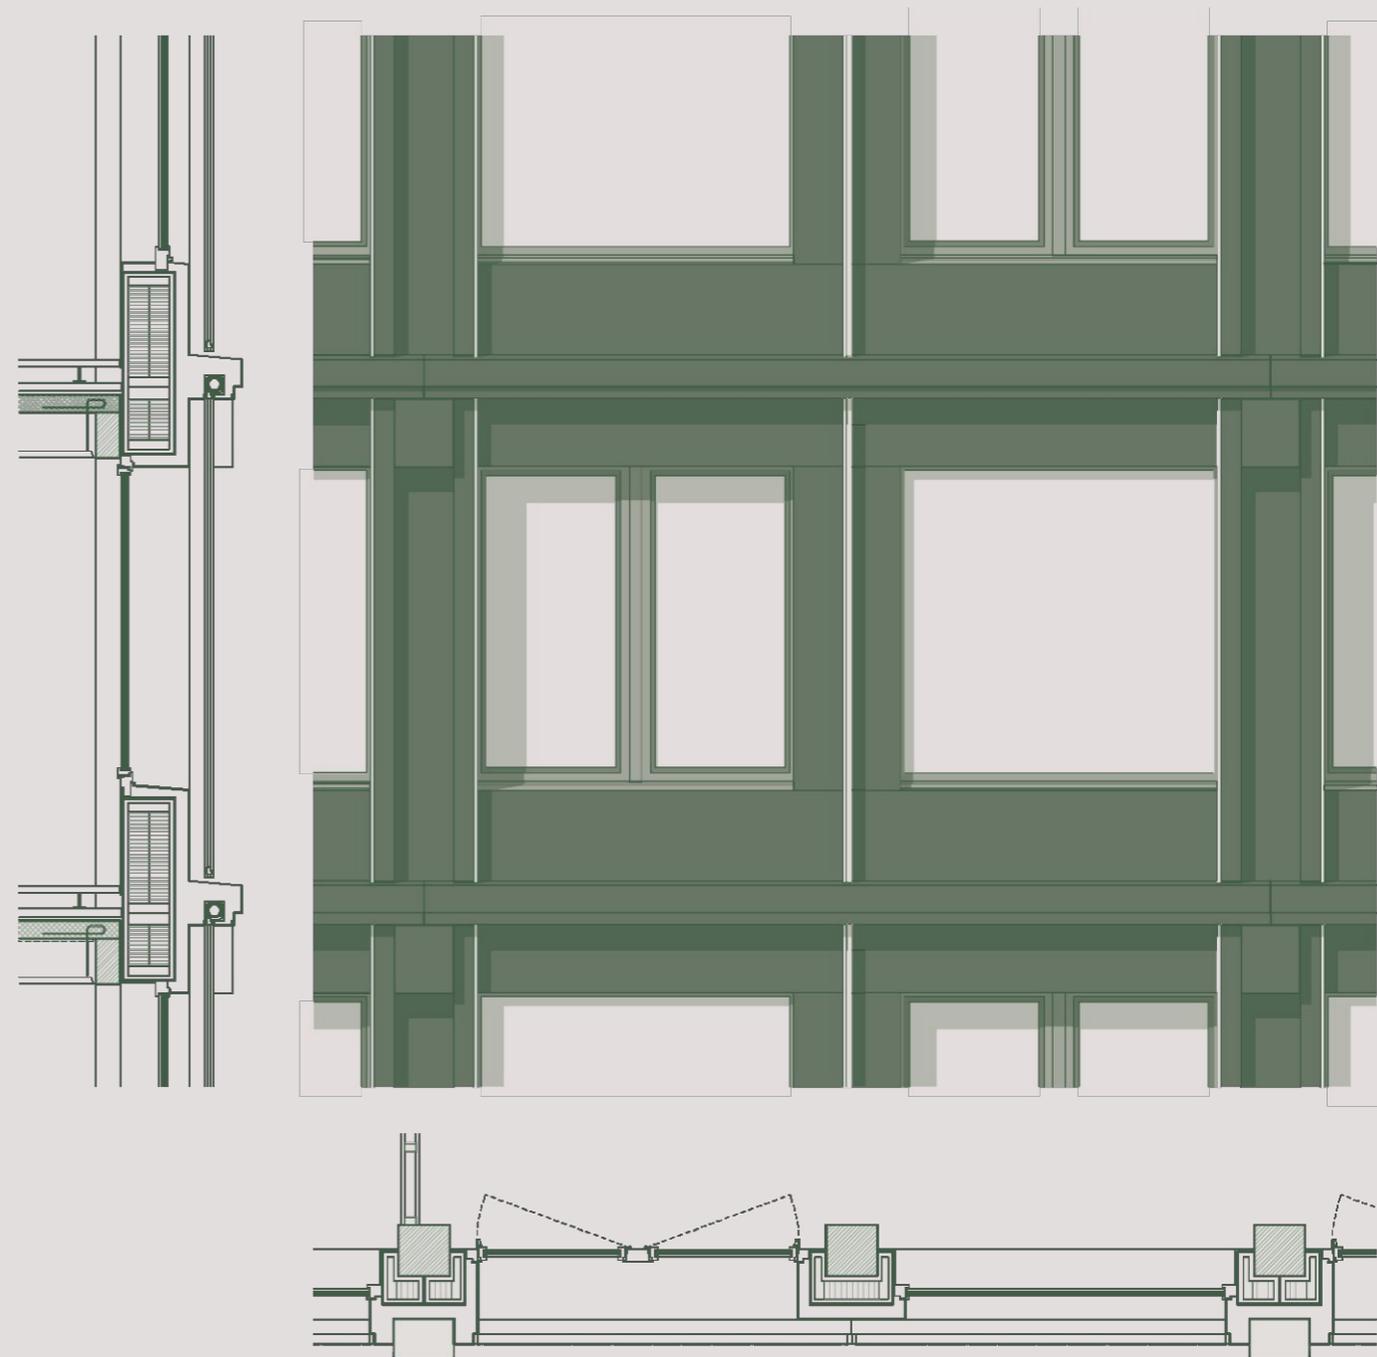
Grundriss & Ansicht M 1:50
